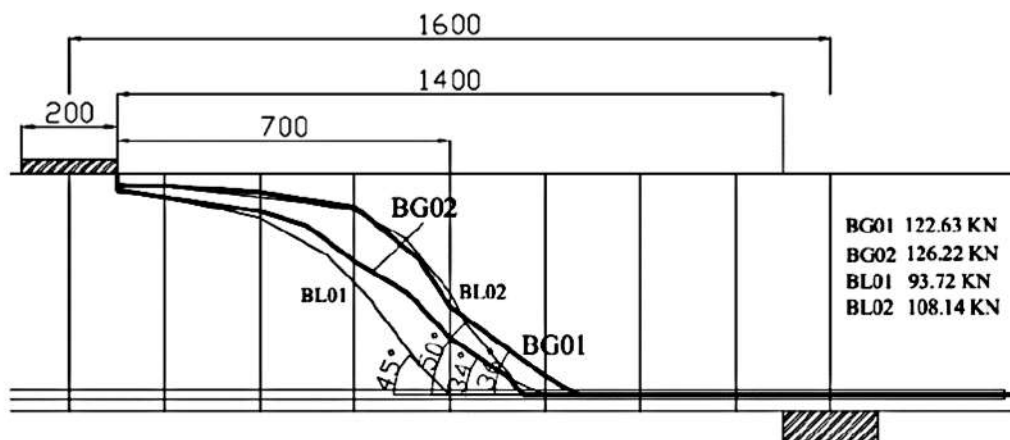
Mapa de fissuração das vigas ensaiadas (SAGASETA, 2008).
